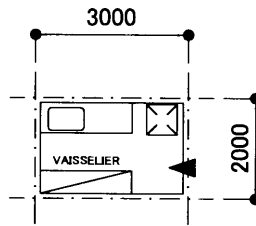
Plan planimétrique du local d’approvisionnement en eau chaude
